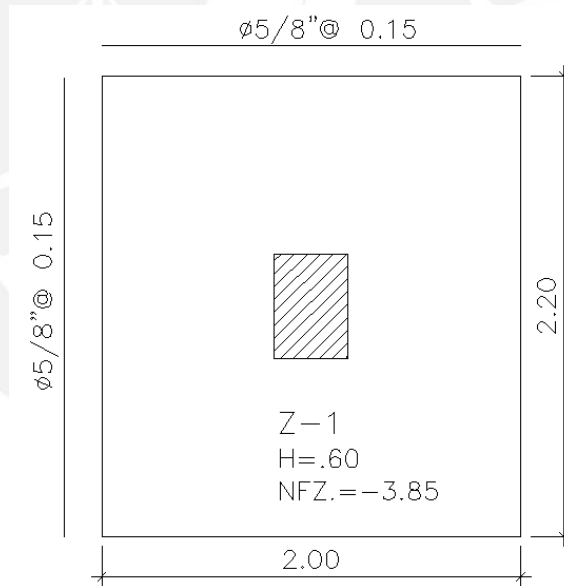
Diseño Final Zapata Aislada Z-1
